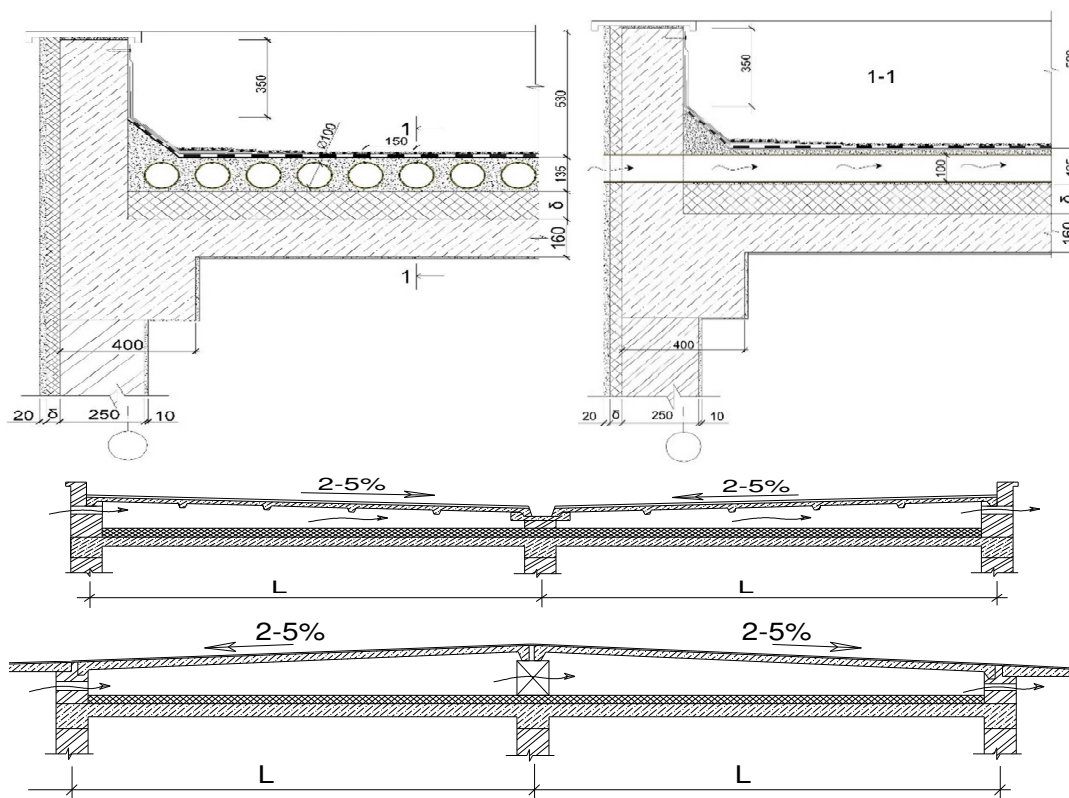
Схемы конструкций бесчердачных вентилируемых крыш.
